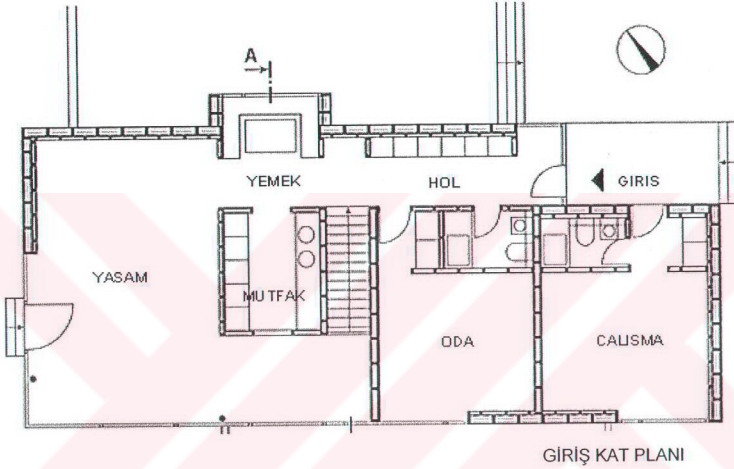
Konut grubu planı , Krapmeier& Drössler (2001)
